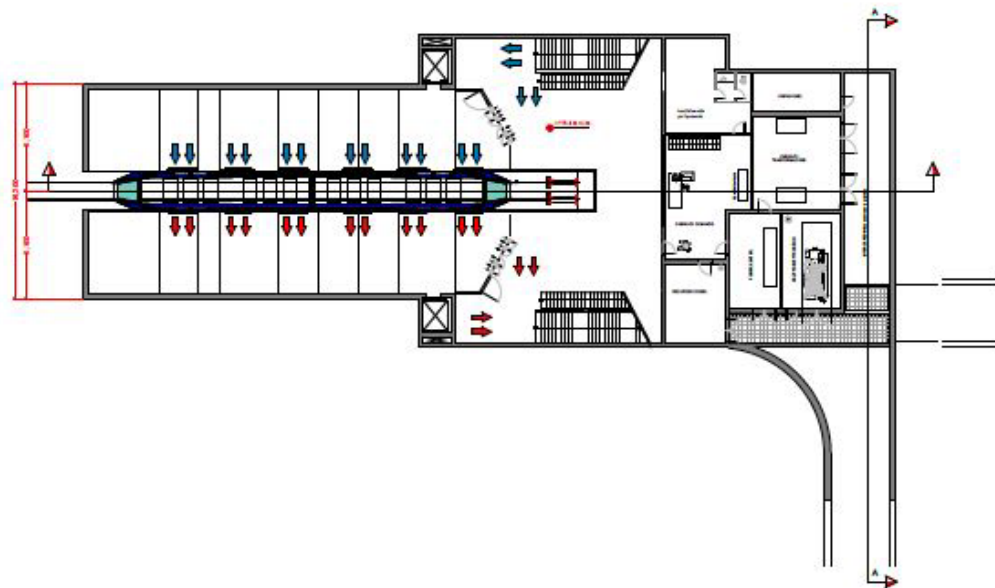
Pianta piano di imbarco/sbarco - stazione "Parco Erzelli"
